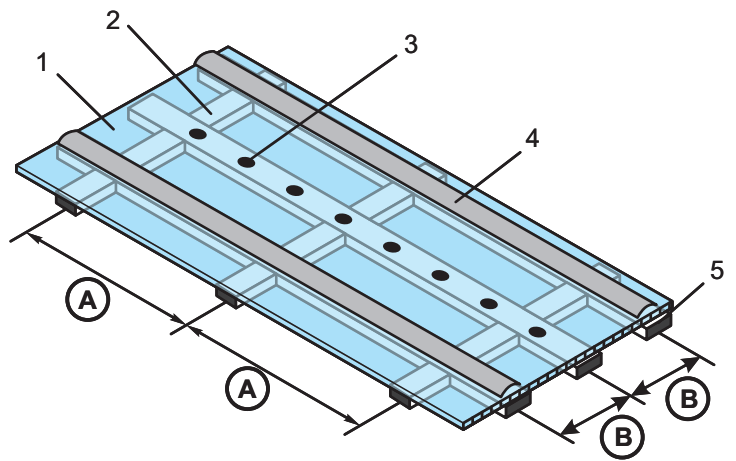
Продольно-поперечная несущая конструкция. 1 - панель сотового поликарбоната; 2 - прогоны; 3 - саморезы с шайбами; 4 - соединительный профиль; 5 - стропила.
